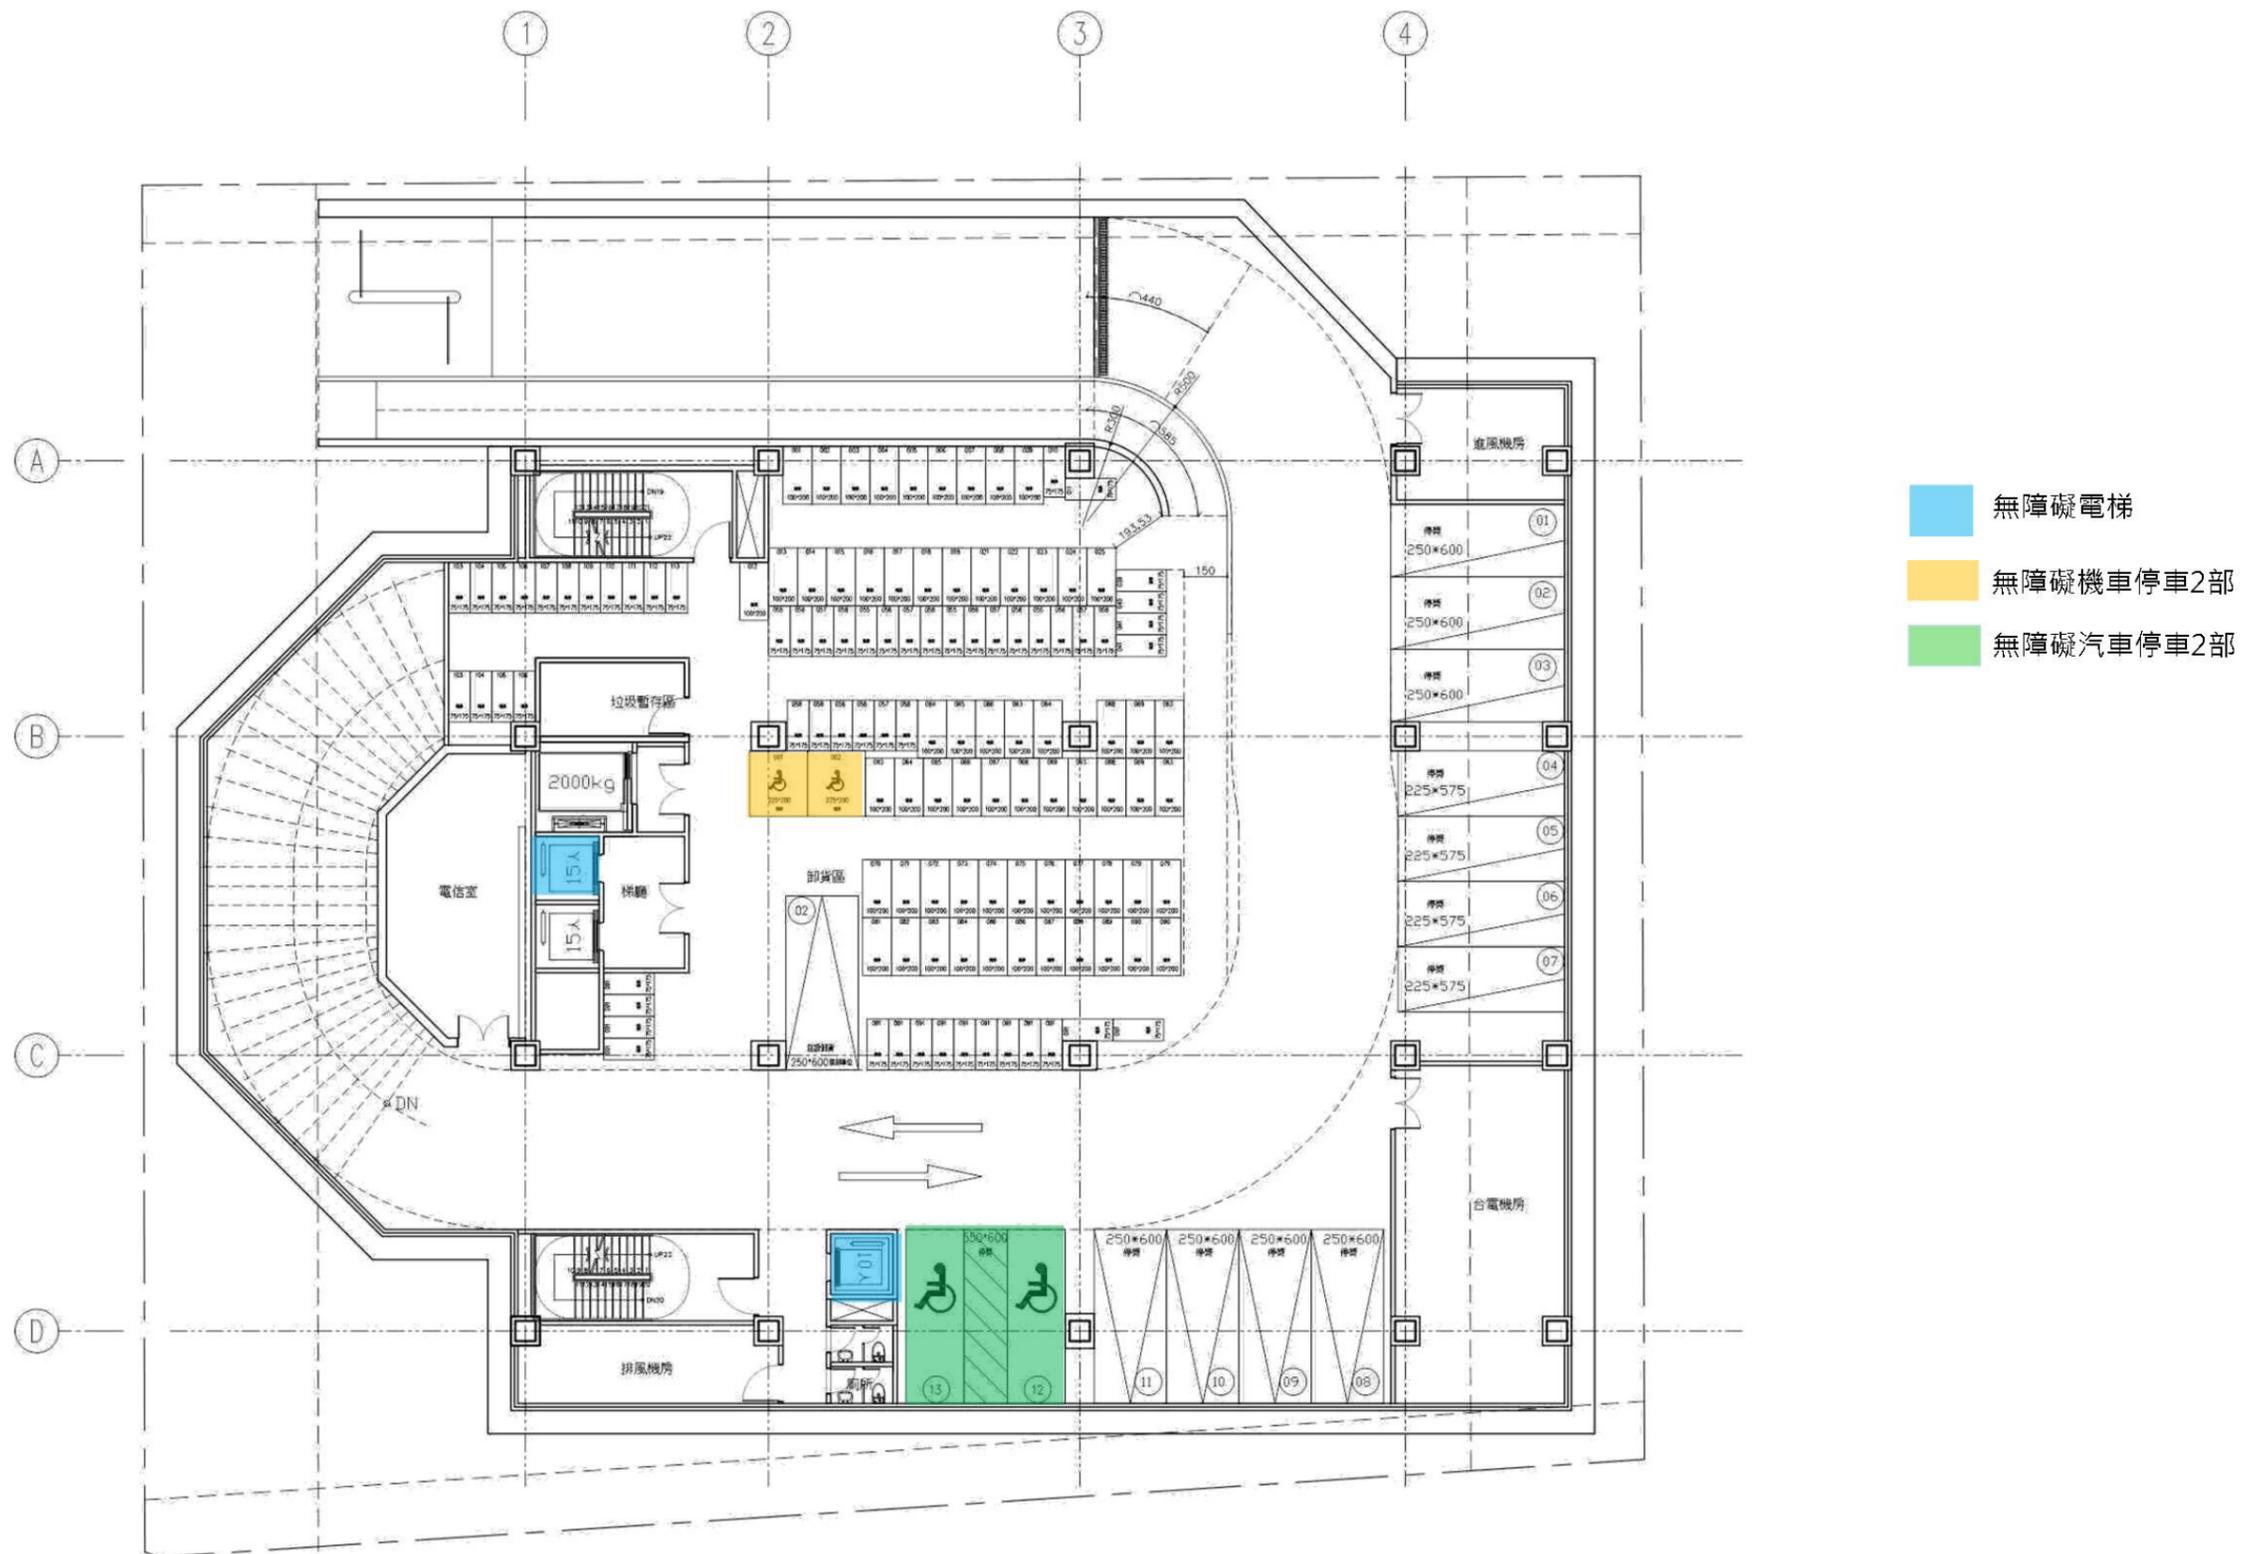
地下一層平面無障礙空間引導設施系統示意圖
